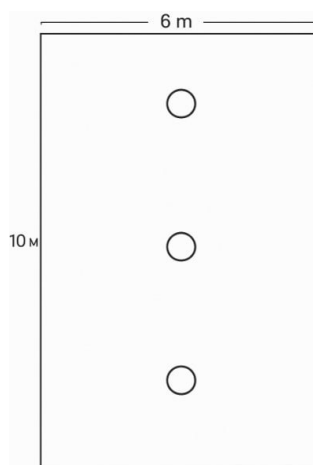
План розташування світильник в типовому приміщенні
